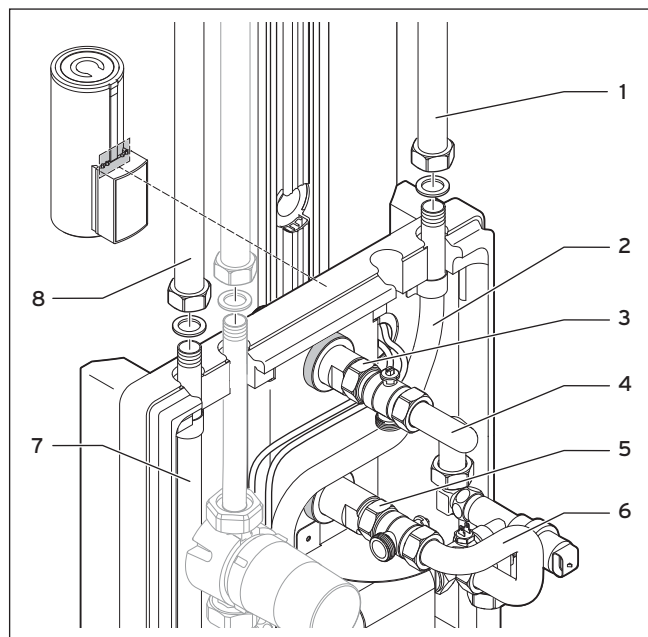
Tubazione di collegamento - montaggio idraulico nell'impianto domestico
